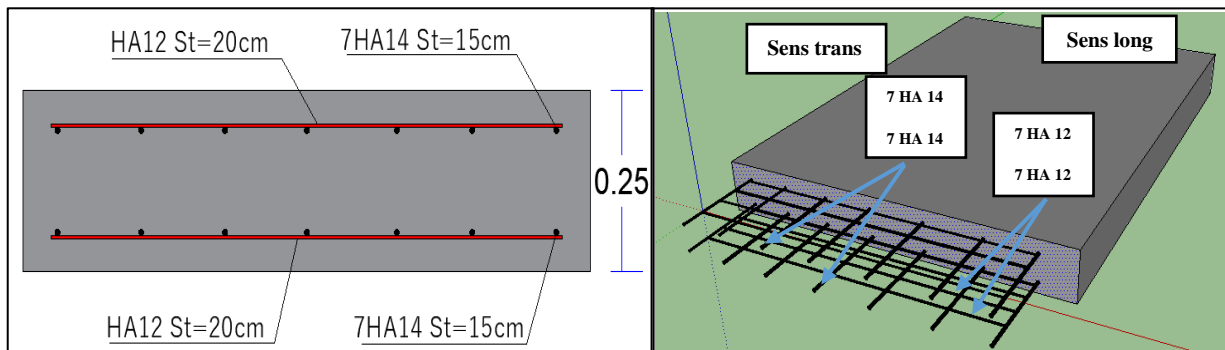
Ferrailage de la dalle (coupe longitudinales)
